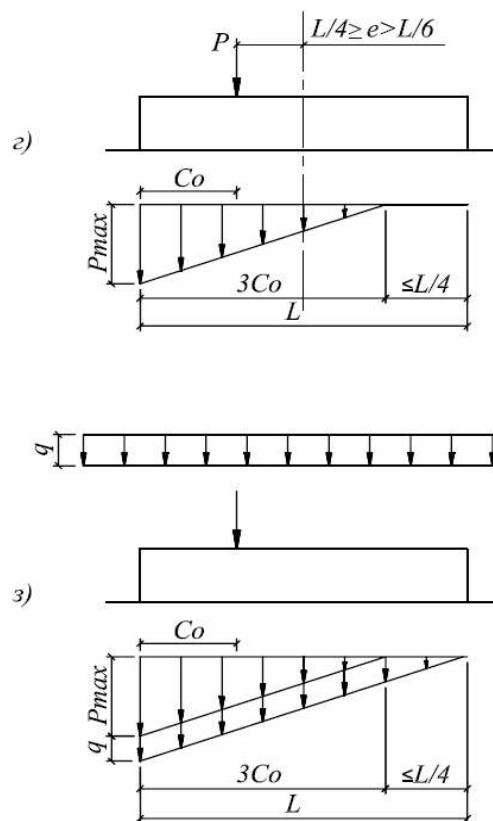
Эпюры давлений по подошве фундаментов при внецентренной нагрузке з и з – при  $e > \frac{l}{6}$  (с частичным отрывом фундамента от грунта)
